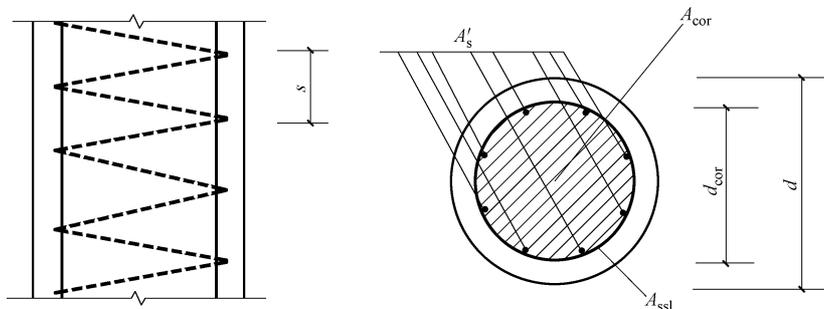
配置螺旋式间接钢筋的钢筋混凝土轴心受压构件
